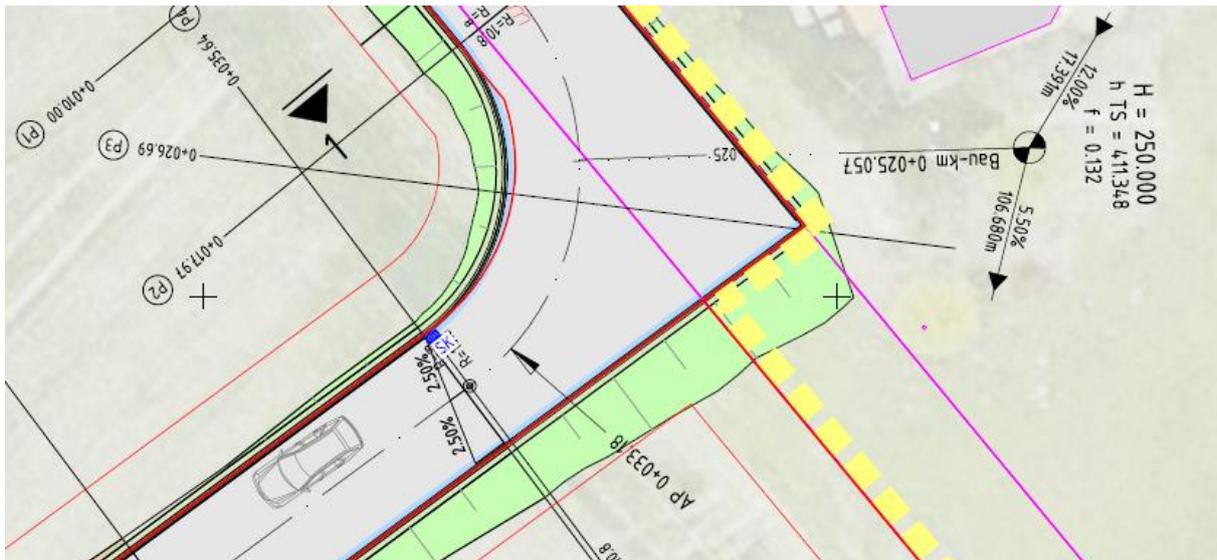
Straßenböschung im Bereich der Feldwegeparzelle (Auszug aus der Fachplanung, Ingenieurbüro Falkenhahn & Partner, Stand 21.04.2020)
